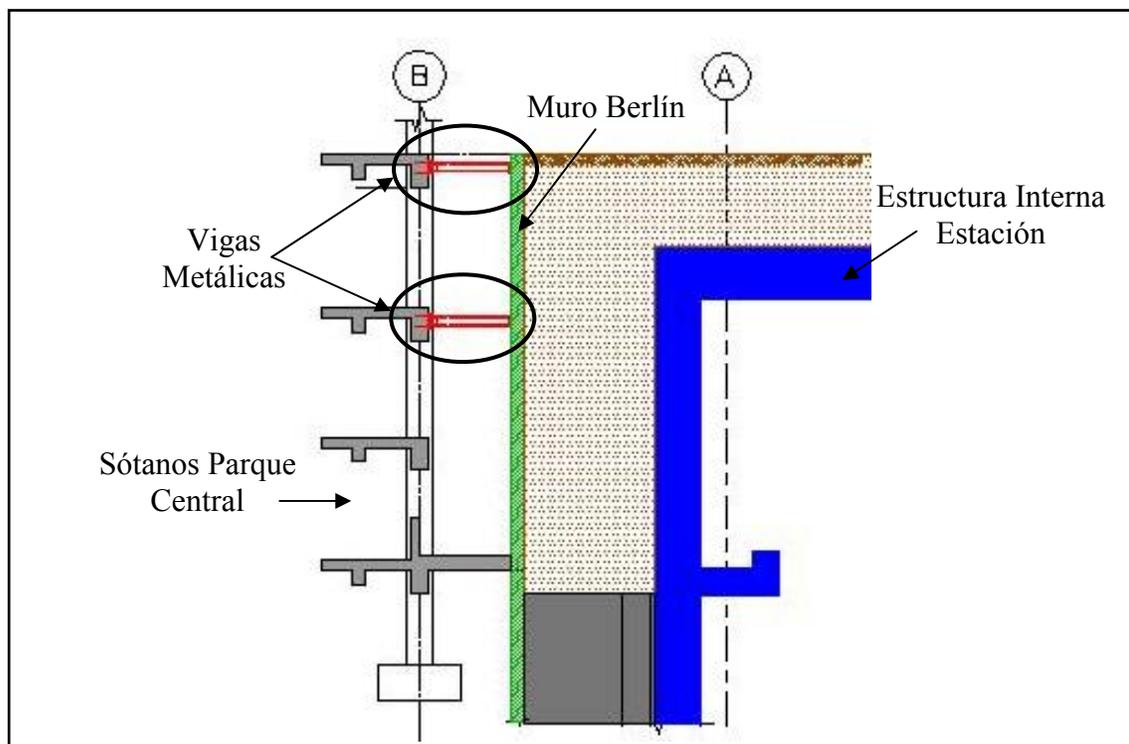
Corte en muro Berlín y vigas metálicas
